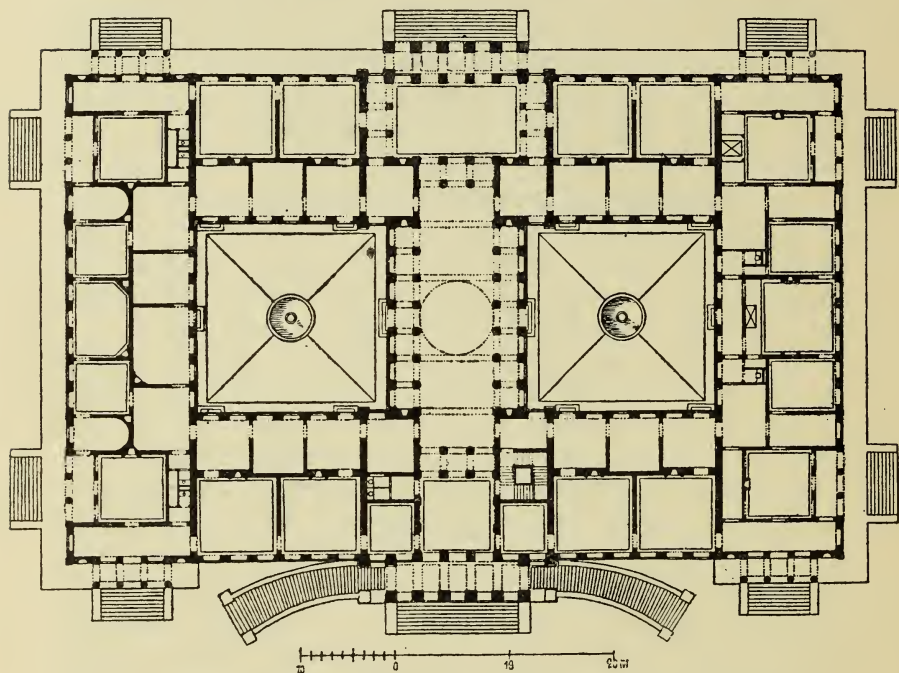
, Landhaus Rosenstein bei Stuttgart. Grundriss. (Aus Leins: Hoflager des Württembergischen Regentenhauses.)
